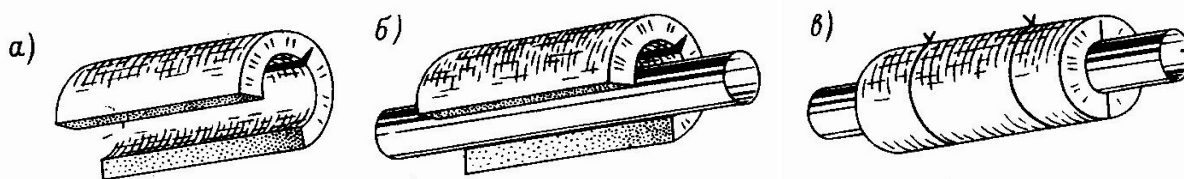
Изоляция трубопроводов минераловатными цилиндрами на синтетическом связующем
